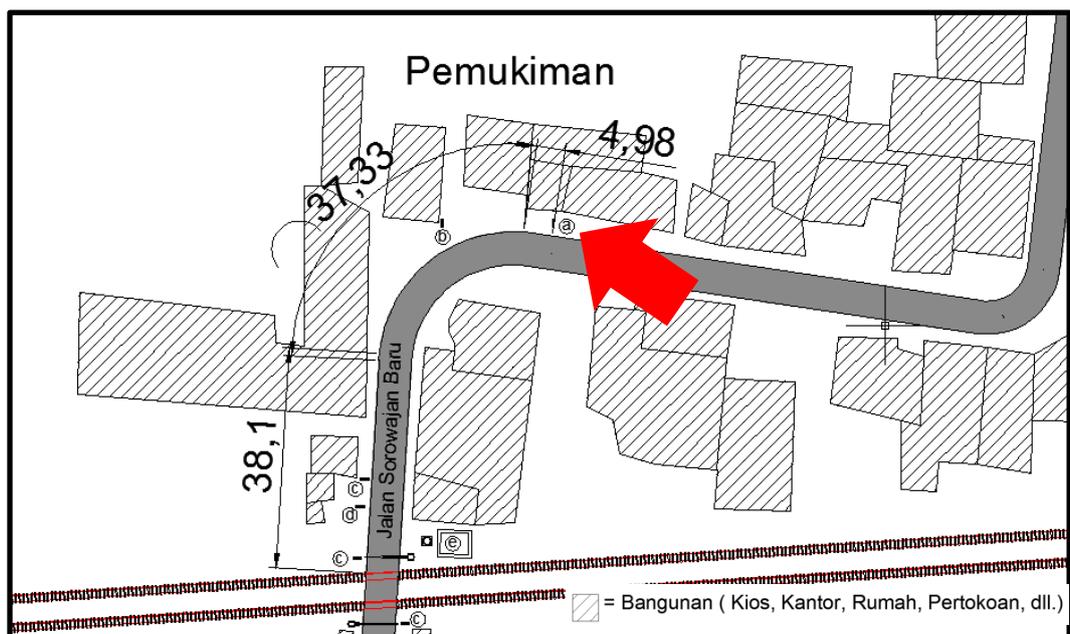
1 Layout panjang jalan lurus pada sisi utara
